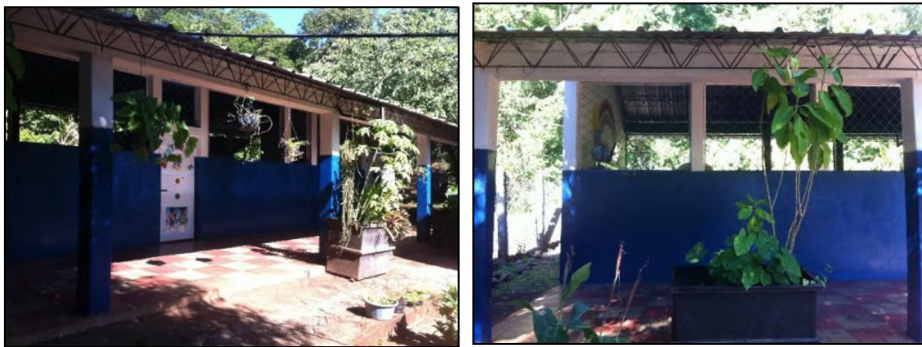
Estructuras de techo con polín espacial y lamina de aluminio.* Fuente: Grupo de investigación.
